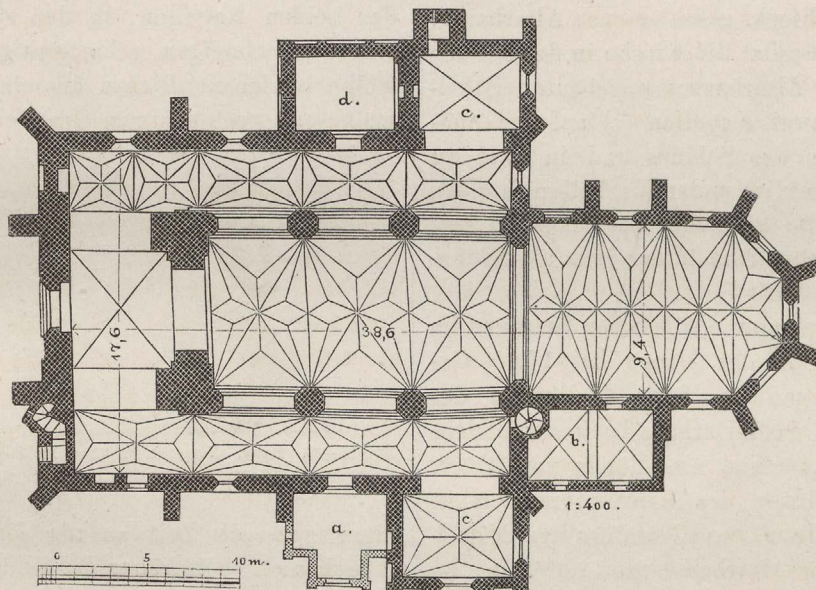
Mewe. Grundriss der kath. Kirche.
